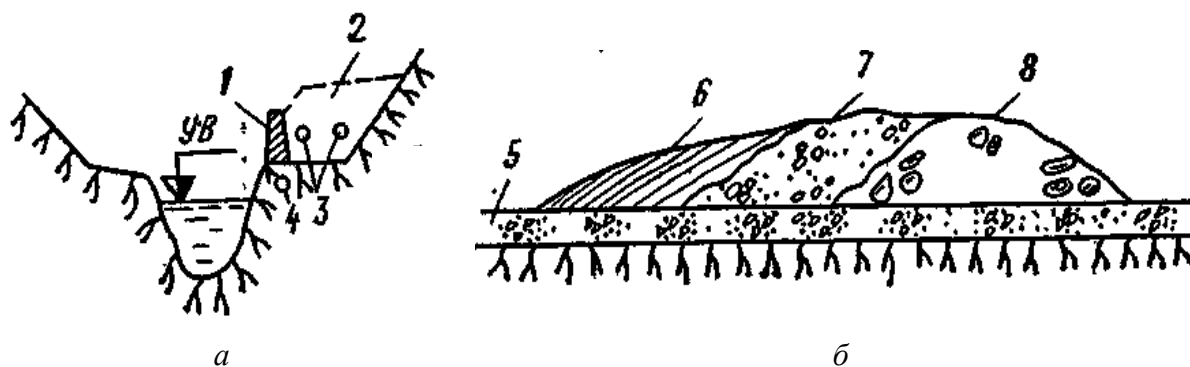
Схема возведения взрывом верховой перемычки Нурекской плотины: *а* – поперечный разрез по складу камня; *б* – поперечный профиль образованной взрывом перемычки; 1 – подпорная стенка; 2 – склад камня; 3 – бетонные трубы для размещения основных зарядов; 4 – заряды для дробления скального берега; 5 – русловый аллювий; 6, 7, 8 – наброска взрывом, соответственно, супеси, гравелисто-галечного грунта и камня
